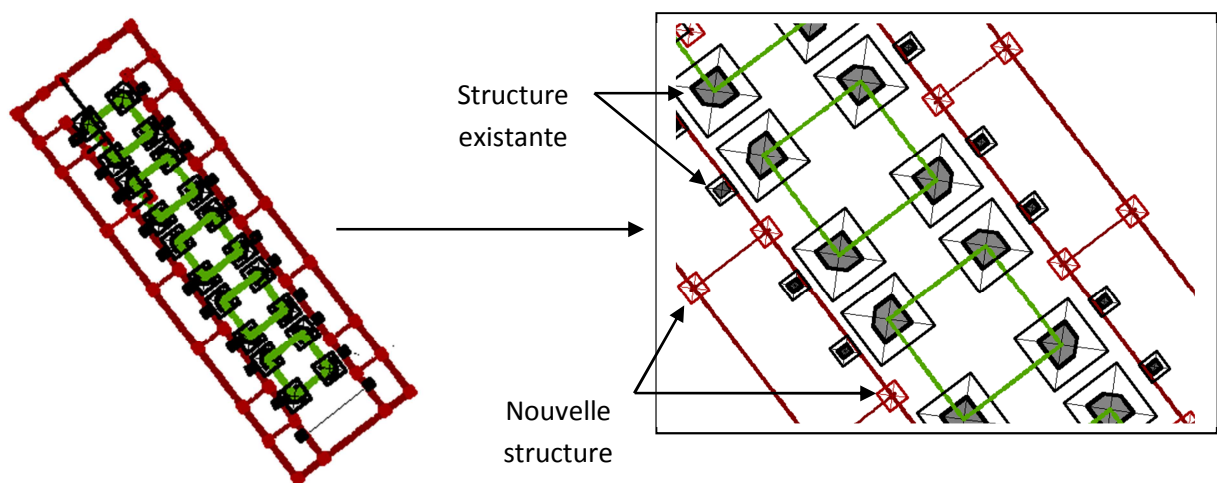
plan des fondations après implantation de la nouvelle structure, source: auteur
